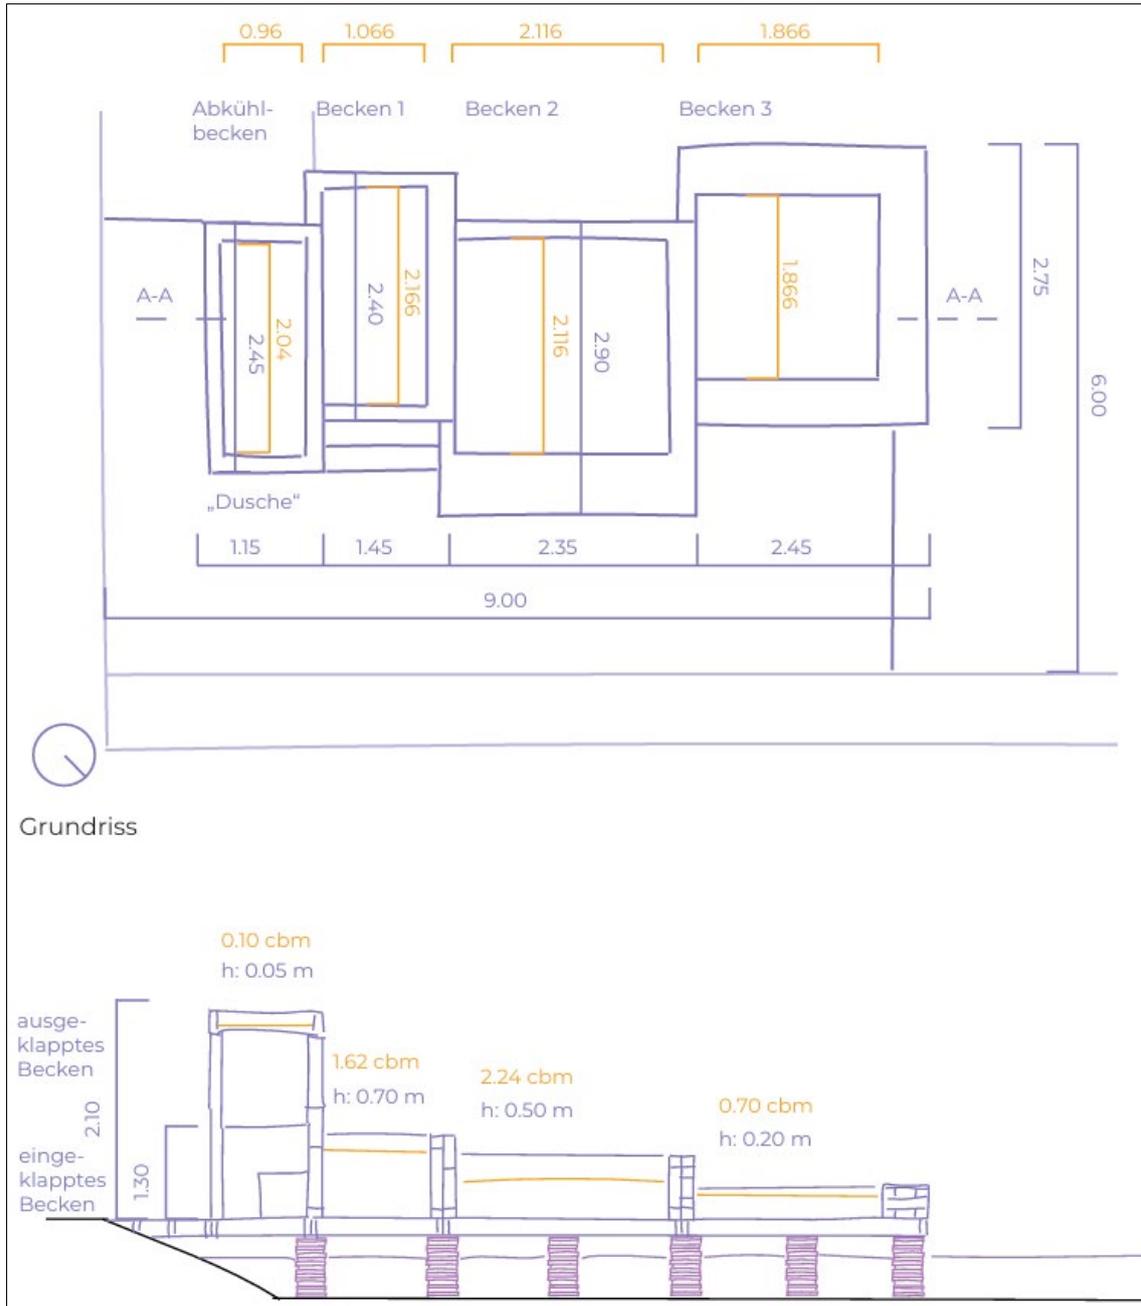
Maße der Anlage (FH Aachen, Fachbereich Architektur)
